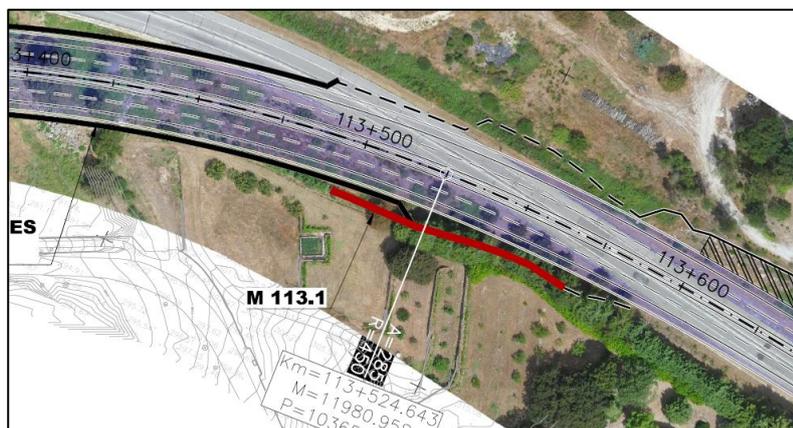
Configuração do muro de betão armado fundado em estacas moldadas M113.1
